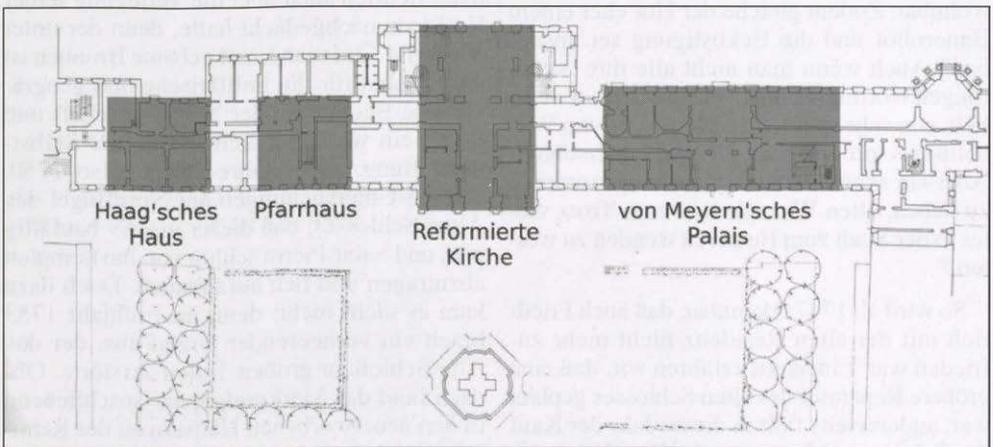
Grundriß des Neuen Schlosses in Bayreuth mit den Vorgängerbauten.
